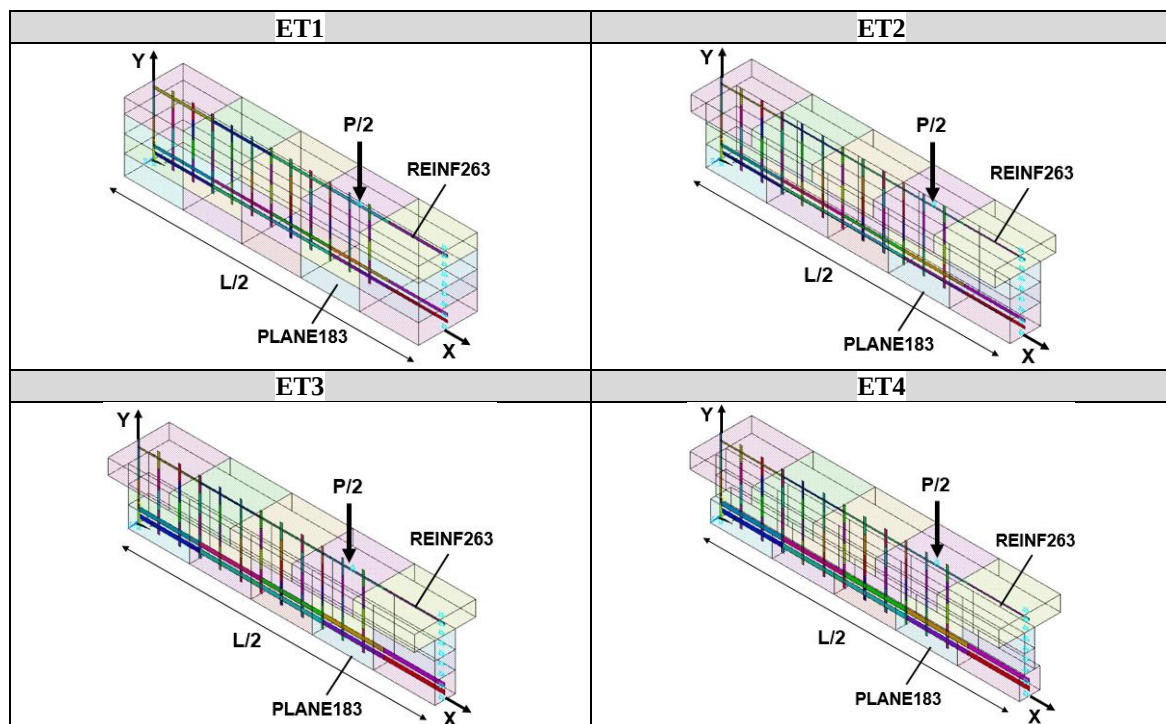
Discretização em elementos finitos para análise computacional das vigas de Leonhardt e Walther (1962)
